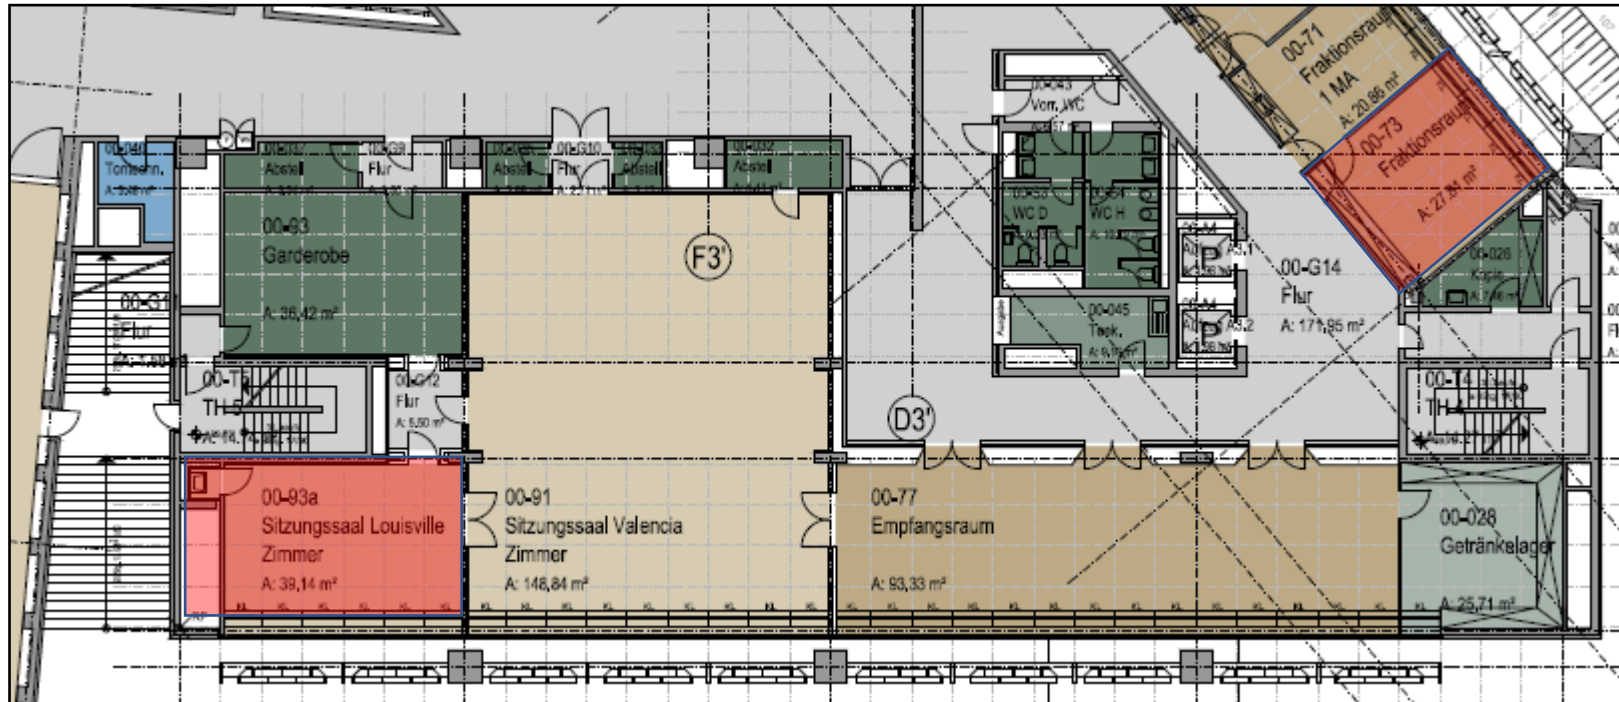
Detail Grundriss, agn Architekten, Januar 2017
